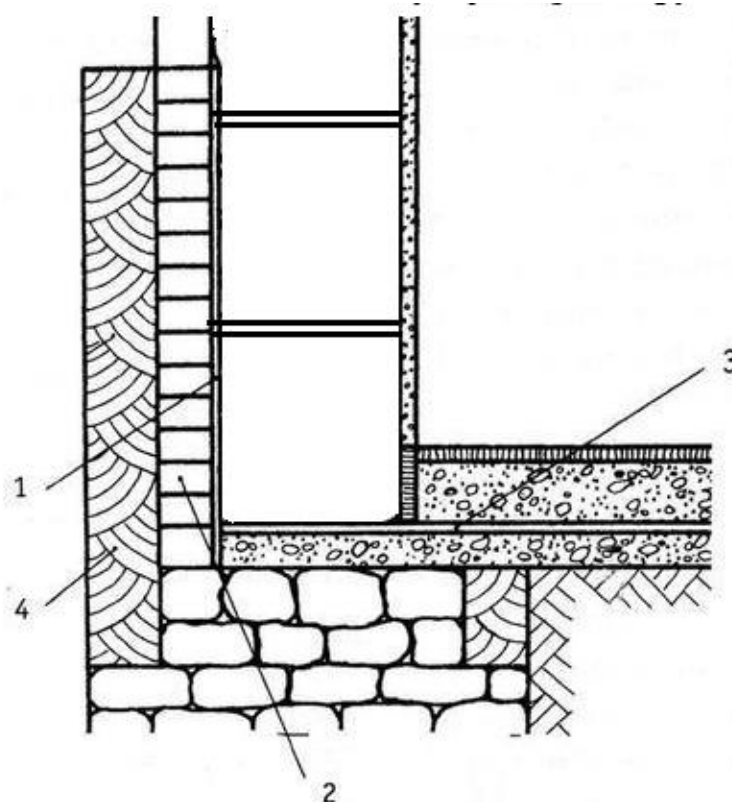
Фундамент с засыпной гидроизоляцией.
